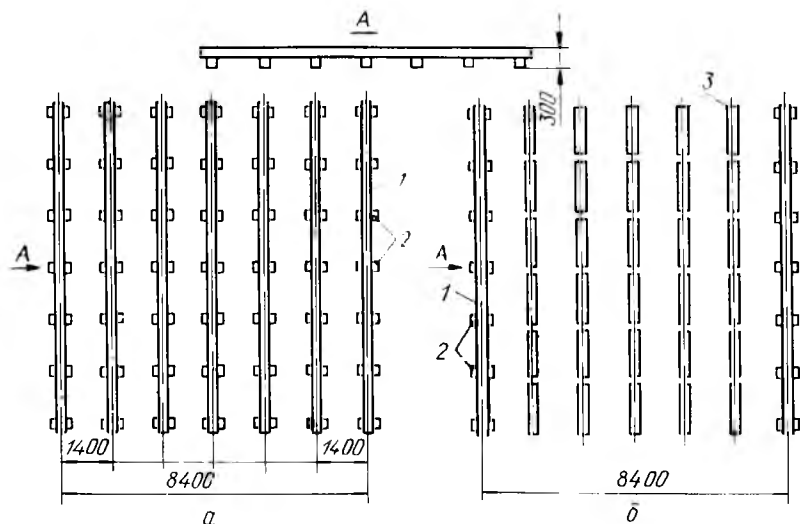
Схема подштабельных фундаментов для укладки пакетных штабелей кранов в закрытом неотапливаемом складе (а) и автопогрузчиком под навесом (б):
